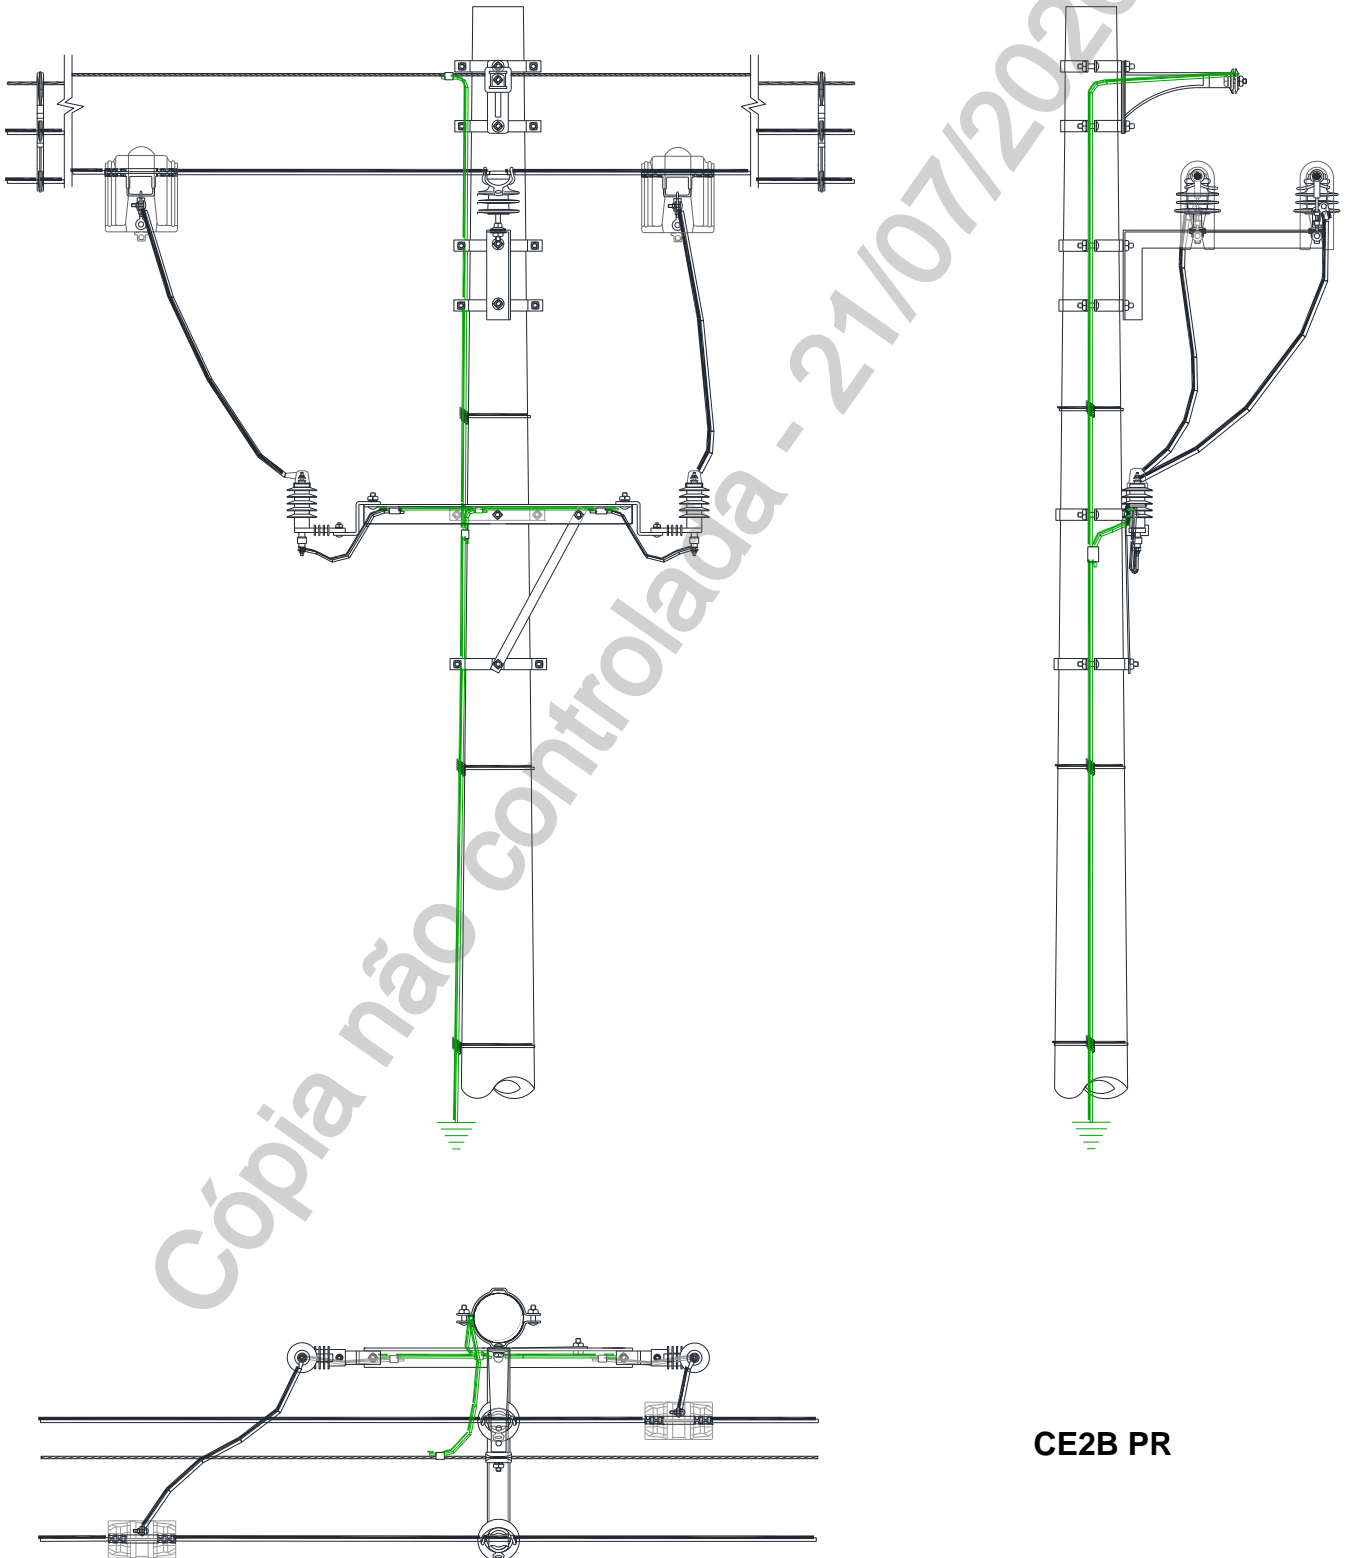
Estrutura Bifásica para Instalação de Chaves
